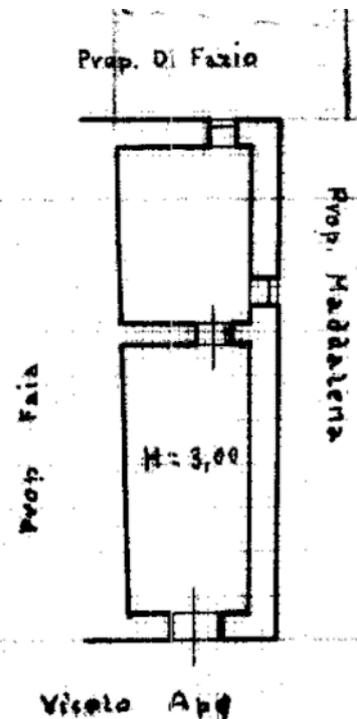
Planimetria catastale attuale (non in scala) dell'immobile pignorato – Lotto A.
